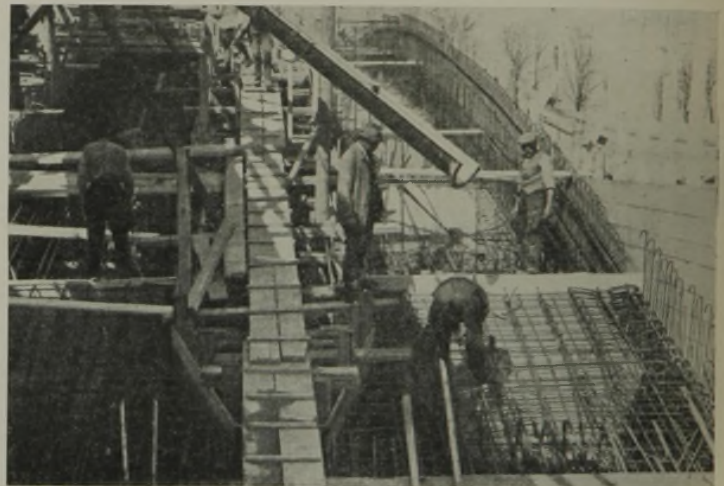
Vor dem Betonieren des Druckhauptes im Kämpfer.
